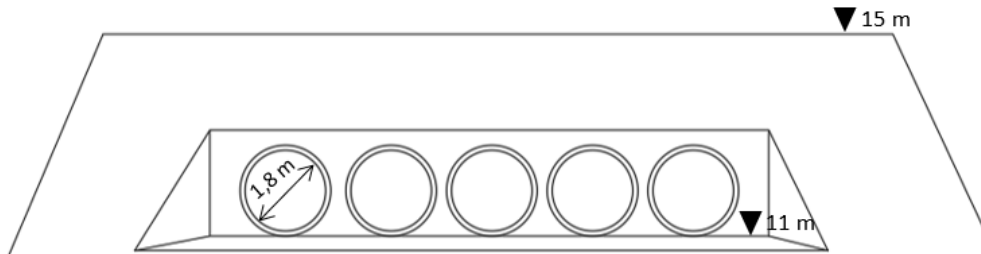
Croquis de la ODT proyectada. 5 tubos Φ 1800mm, aletas 75°.
